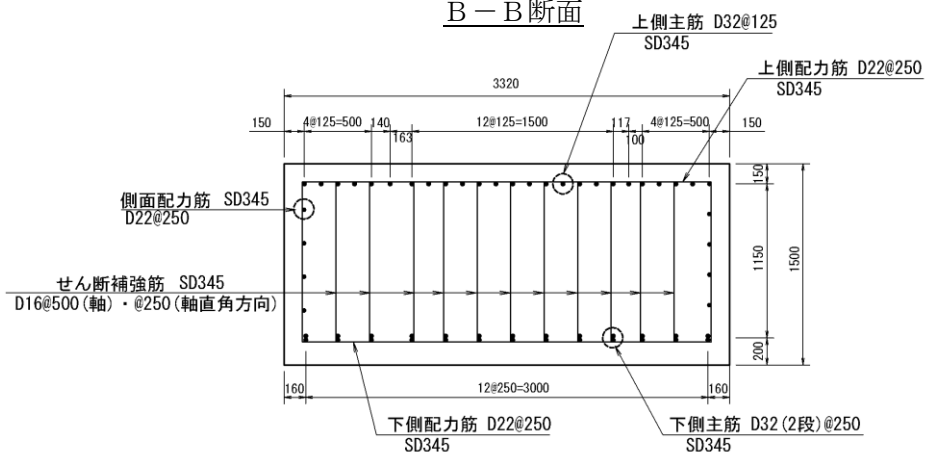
(2) 防波扉 (荷揚場南) 基礎スラブ配筋図
